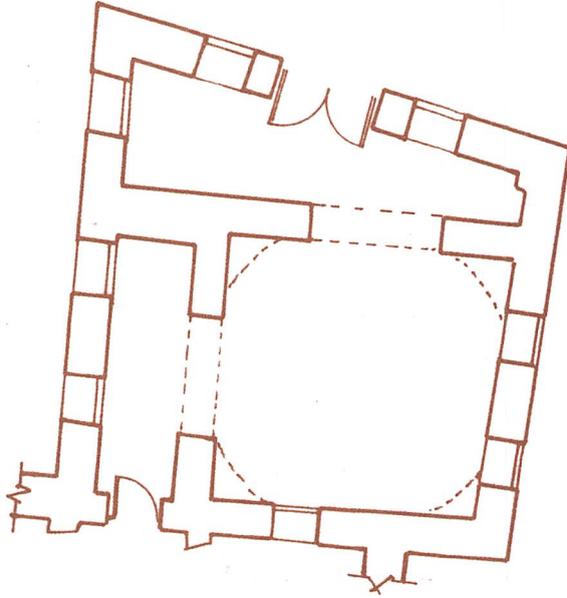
المسقط الأفقى لمسجد وضريح الحبشى بدمنهور
